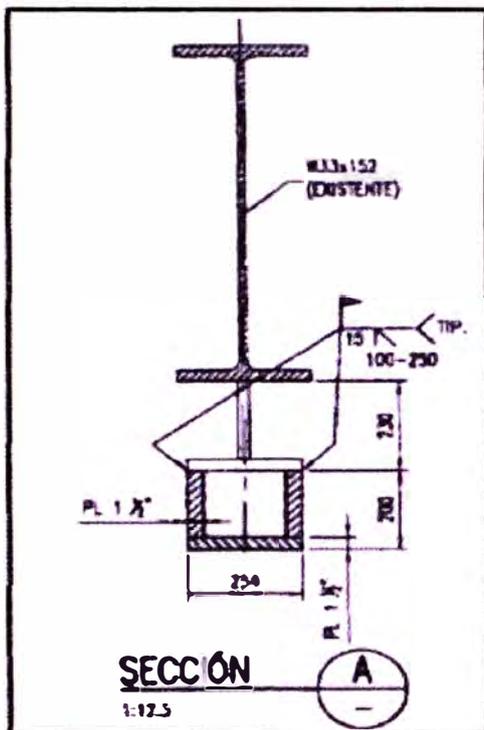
Detalle Frontal de reforzamiento de viga V-1
